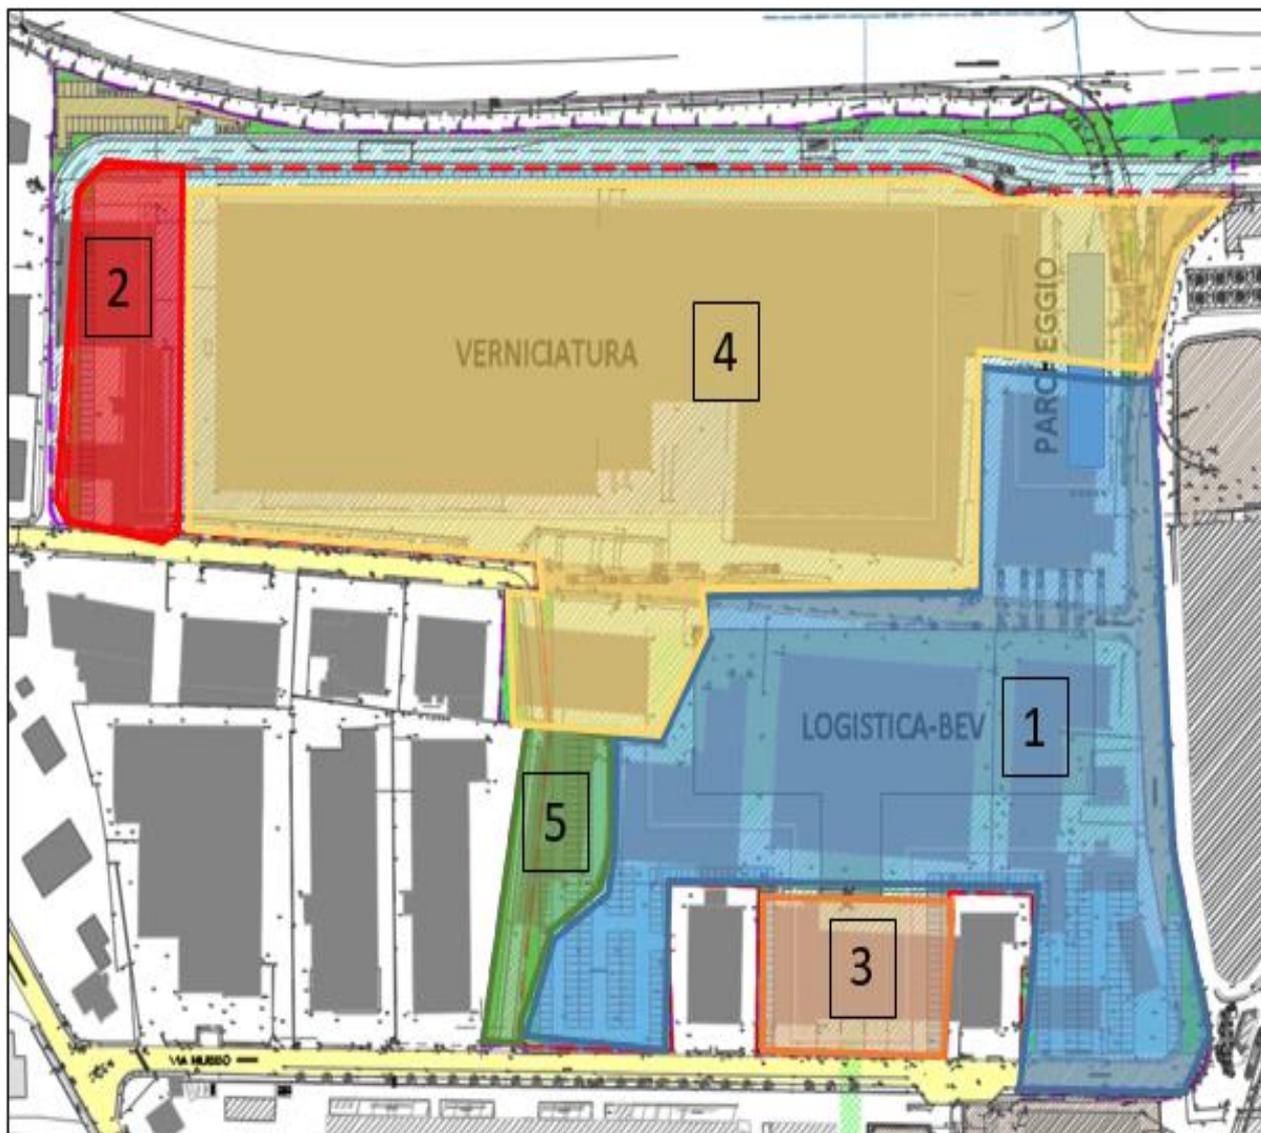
Sovrapposizione del progetto alla planimetria catastale dell'area
